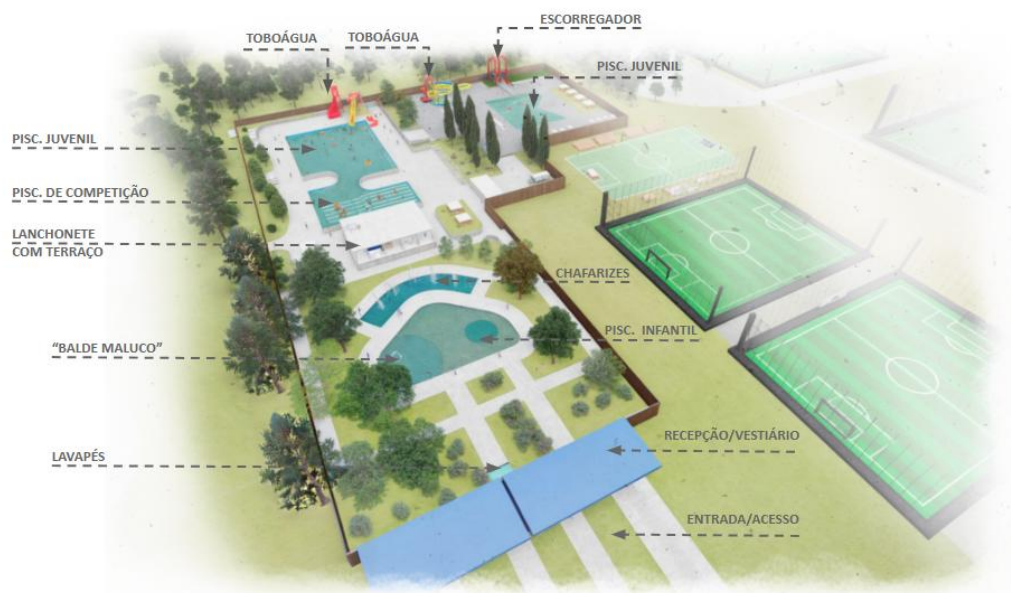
Croqui conceitual do Conjunto Aquático do Núcleo Engenheiro Goulart
